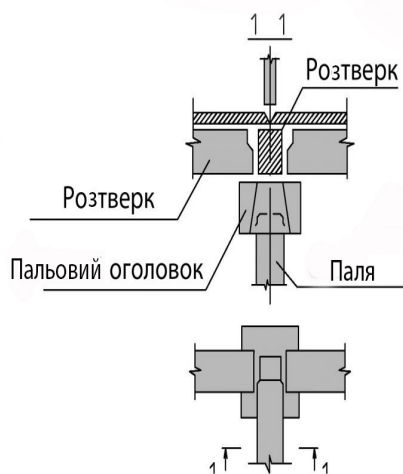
Конструктивний вузол пальового фундаменту з ростверком
